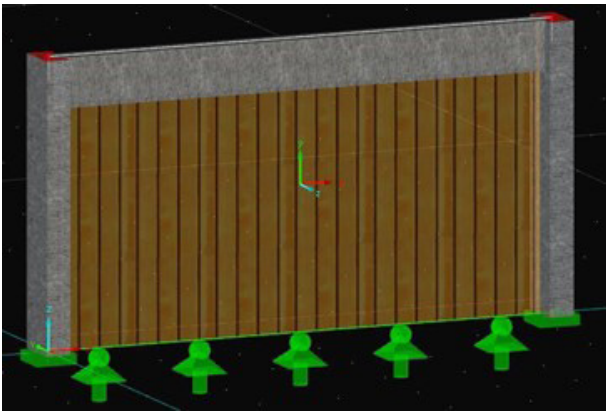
Sistema pilastro-trave con muro in CLT compreso. Elaborata dall'autore
